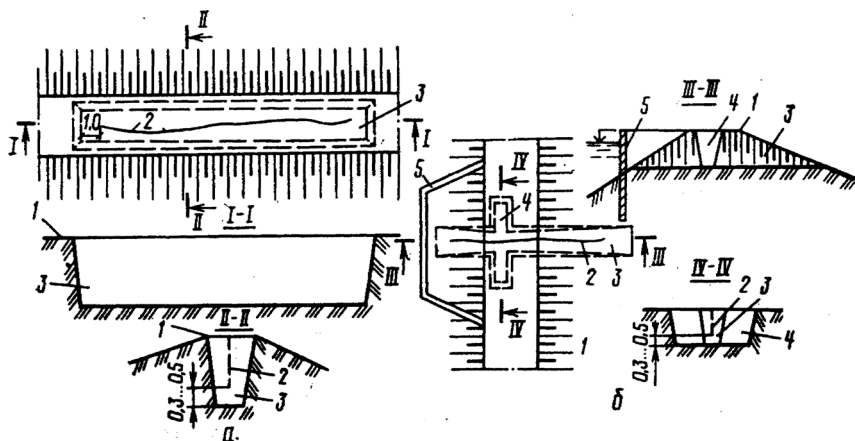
Заделка трещин грунтовых плотин: а – продольной; б – поперечной; 1 – гребень плотины; 2 – трещина; 3 – траншея; 4 – замок траншеи; 5 – шпунтовое ограждение
